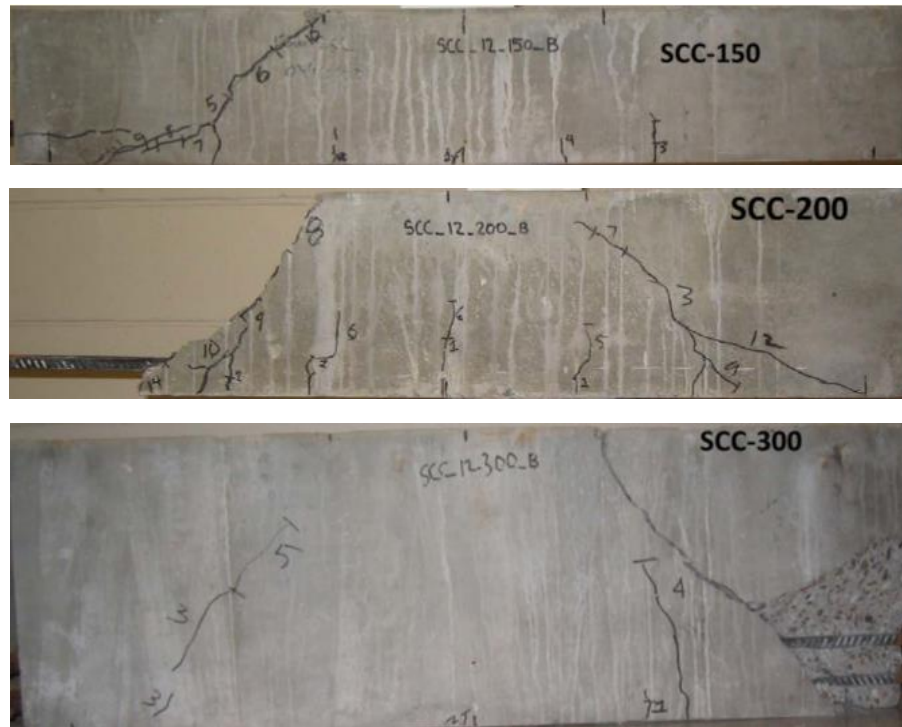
Padrão de fissuração das vigas de CAA-150, CAA-200 e CAA-300 (Sathiyamoorthy, 2016).
